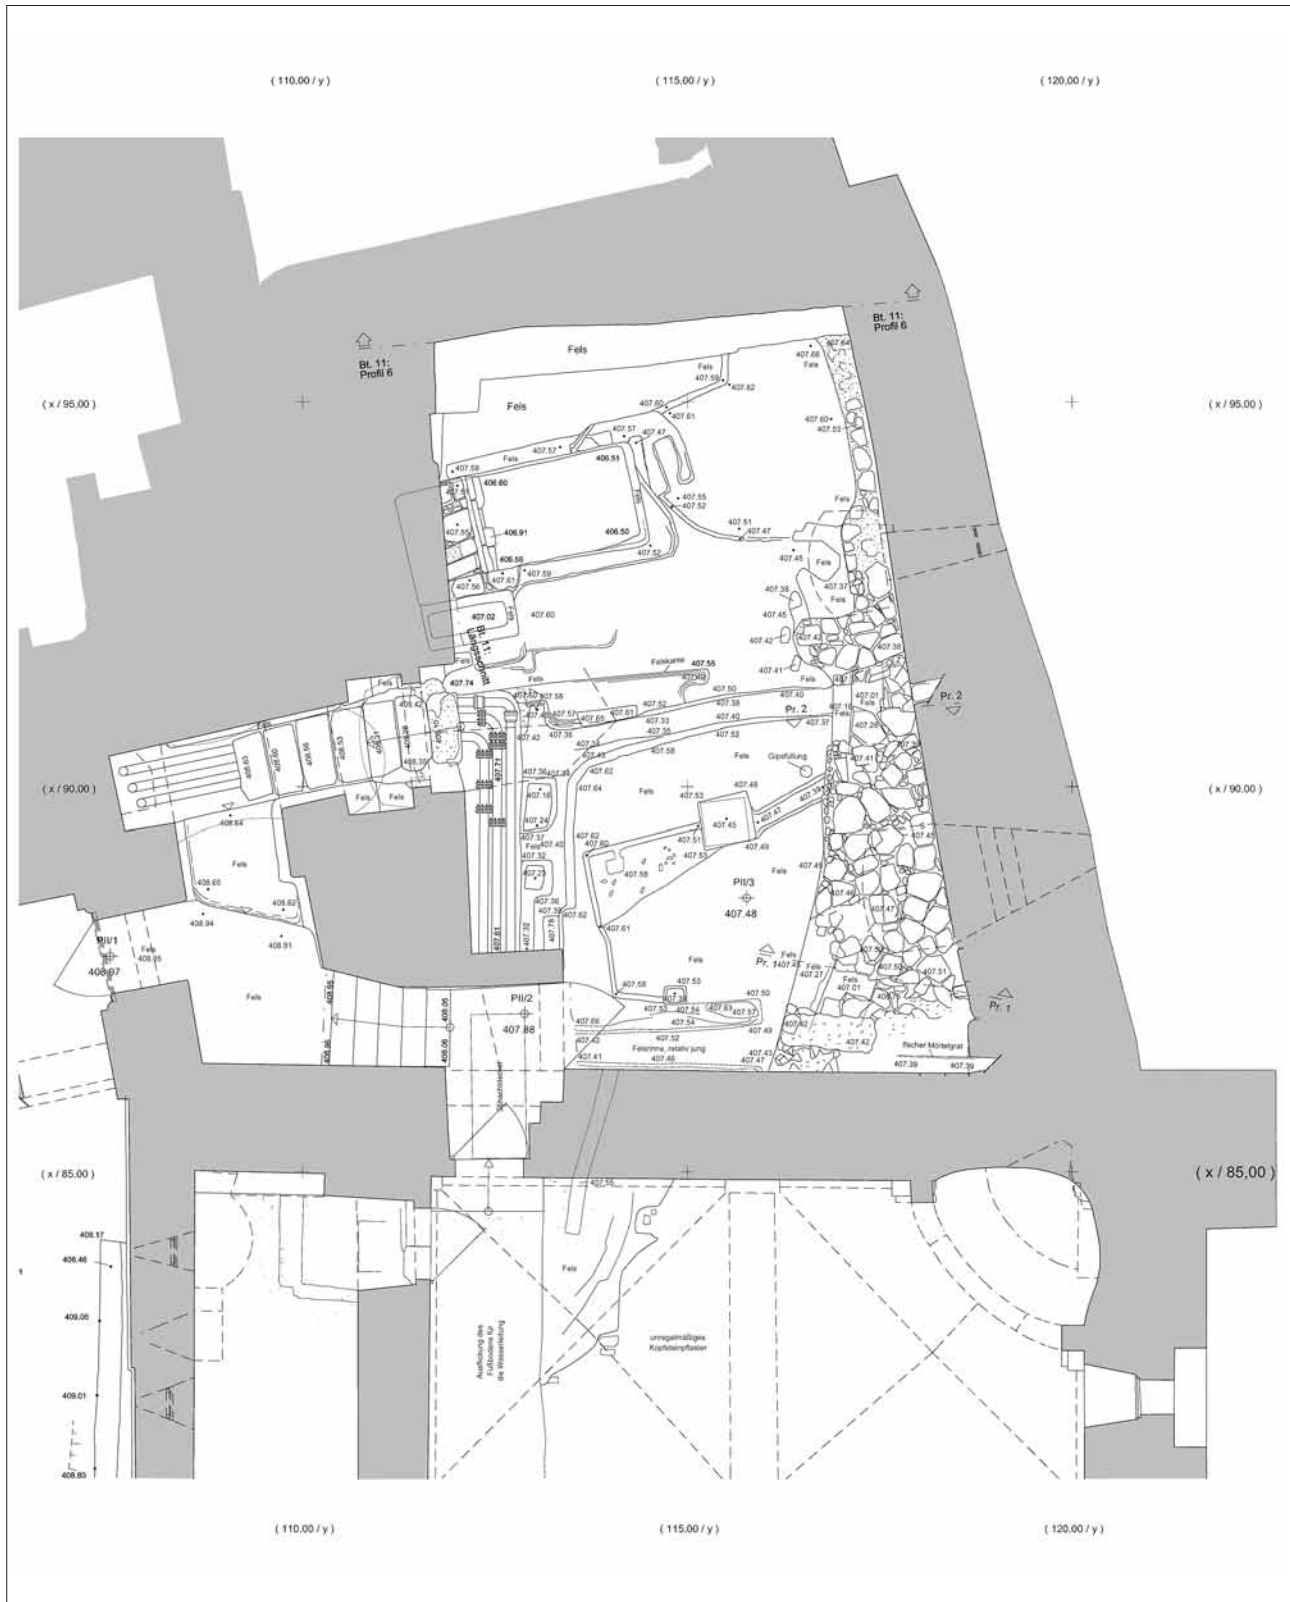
Grundriss der Ebene I mit dem untersuchten Keller (oben). Im Südwesten die vorgelagerte Treppenanlage mit dem älteren nördlichen und dem jüngeren, erst im späten 19. Jahrhundert angelegten südlichen Zugang (siehe den Grundriss um 1880 bei Baumgärtel 1907, 138). Im Boden des nördlichen Zugangs verlaufen die Versorgungsleitungen des 19. Jahrhunderts, die dann im eigentlichen Kellerraum nach Süden abknicken zu einer Trasse entlang der westlichen Widerlagermauer und ab der inneren Wange des jüngeren Zugangs abgedeckt sind. Im Nordosten eine große, aus dem Felsen geschrotete Grube mit den Maßen von 2,55 m in Ost-West-Richtung und 1,6 m in Nord-Süd-Richtung, die im Westen ein Stück unter die Widerlagermauer des Kellers läuft. Nach der Aufnahme der jüngeren Fußböden liegt auf dem größten Teil der Grundfläche der geglättete Felsen frei, in den nachträglich jüngere Installationen eingetieft wurden; eine ältere Ausnahme ist ein keilförmig nach Süden breiter werdender Bereich an der Ostmauer, der mit Bruchsteinmaterial in viel Mörtel verfüllt war und hier den wichtigsten Befund darstellt.
